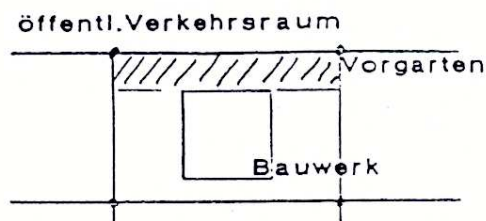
Vorgarten in bebauten Innenbereichen (§ 34 BauGB)
